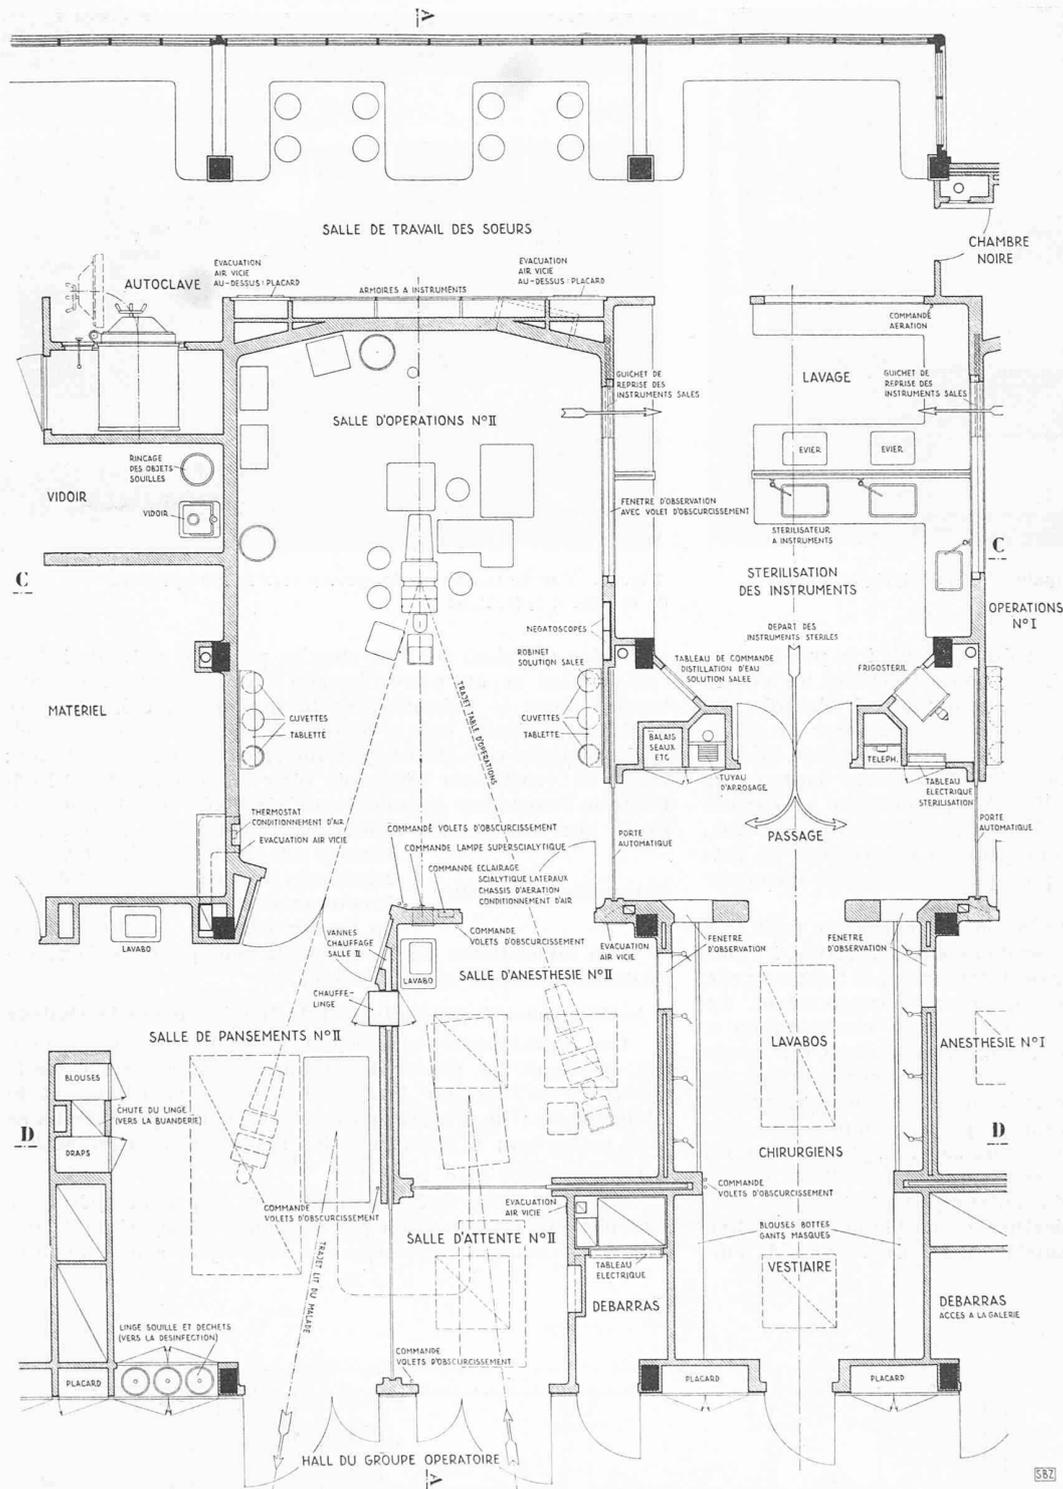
Groupe d'opérations formé par les salles I et II, plan à l'échelle 1:100
